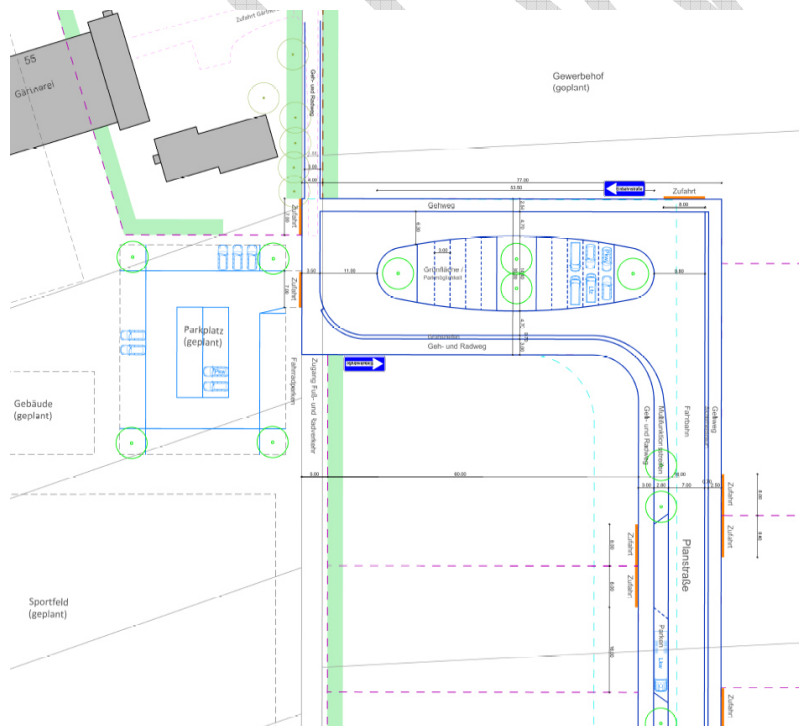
Ausschnitt Wendeanlage und Parkplatz Sportanlage (vgl. Plan Nr. 7, Planungsbüro Karin Weber)
